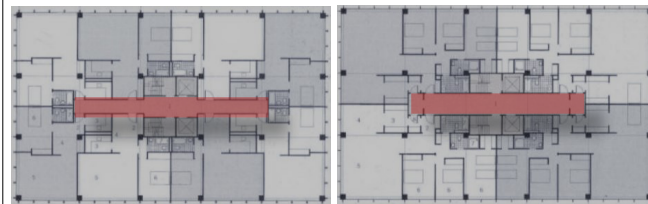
Planos de planta de los apartamentos, bloque 1 y bloque 2. Modificado por el autor.
